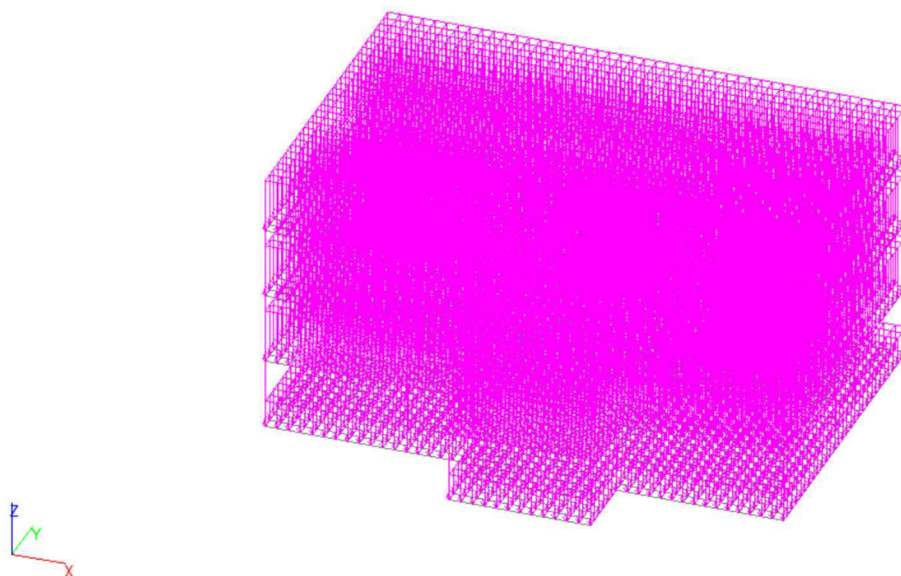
Общий вид постоянного нагружения перекрытия от собственного веса плиты и конструкций пола
